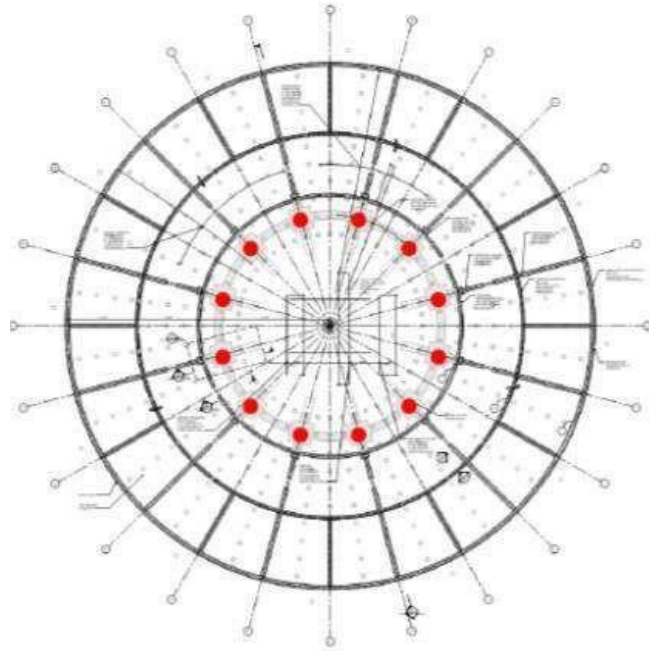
Plano de los cimientos que muestra la ubicación de los soportes de aislamiento (en rojo) NAICM
